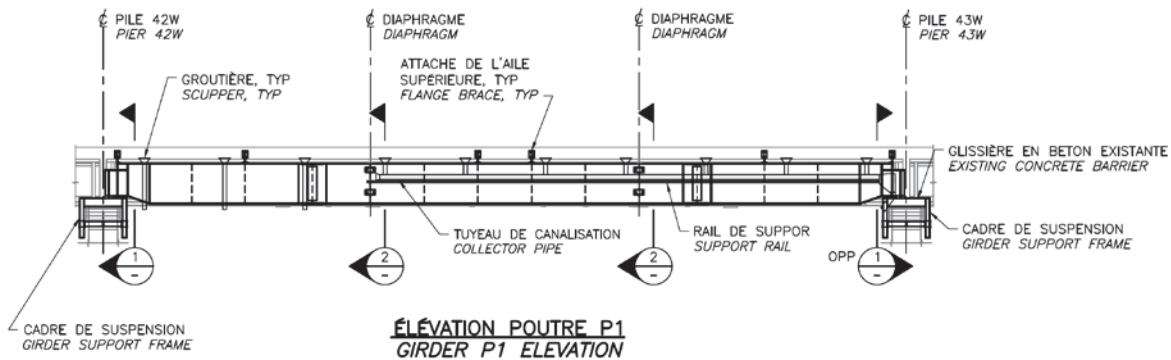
Poutres en béton – Renforcement par poutres auxiliaires (source : ct 62414-125814-1004)
